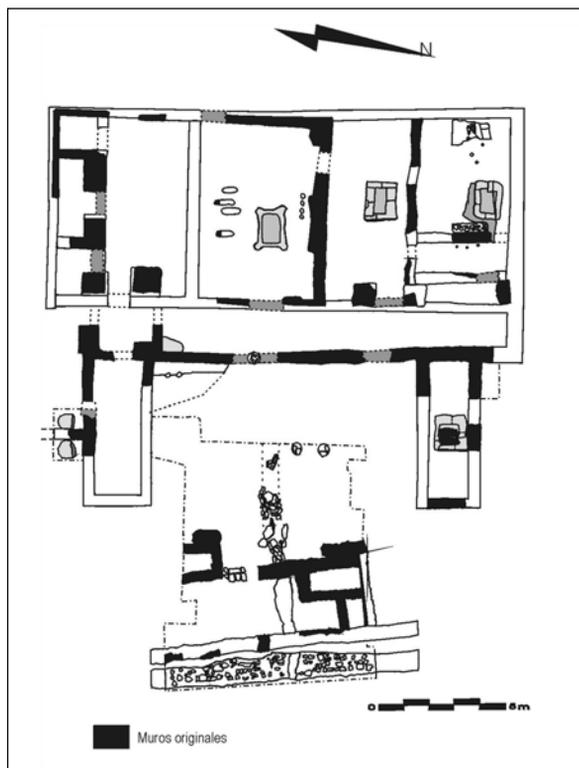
Planta de Cancho Roano B (Según Celestino 2001: fig. 16).
